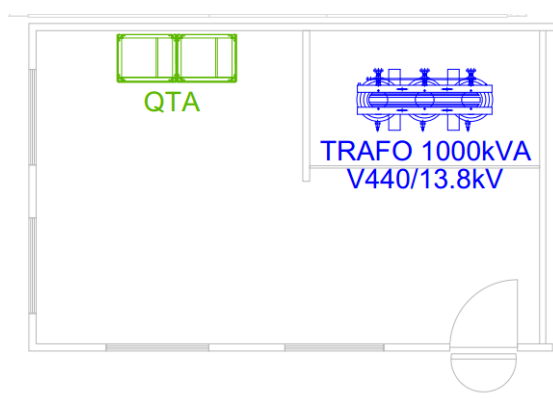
Implantação do Trafo 1000 kVA e QTA Segunda Pavimento
